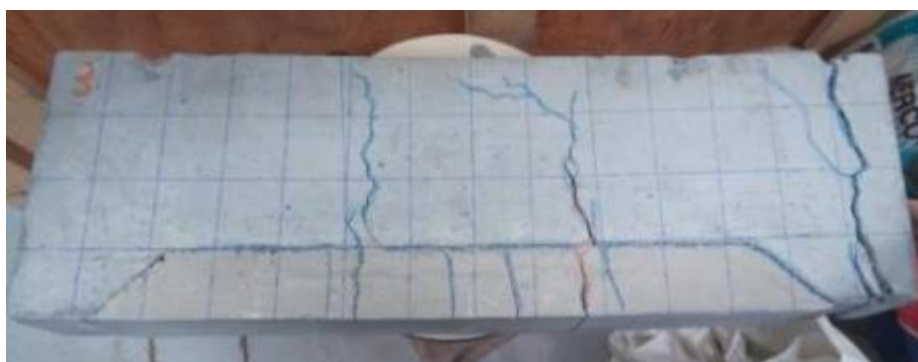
Deslocamento do reparo em vigas com reparo trapezoidal.
